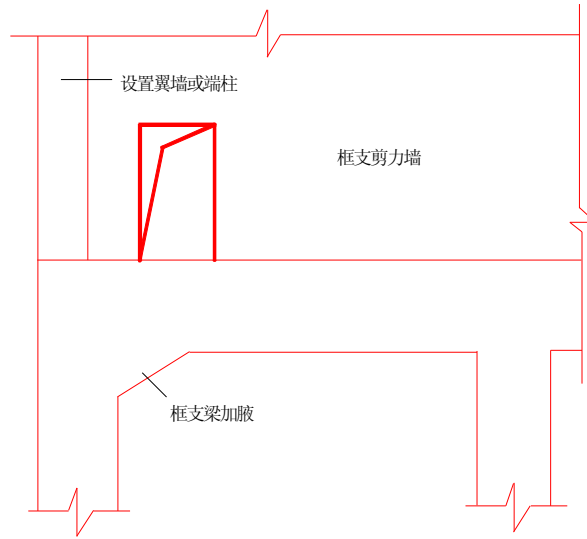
框支梁上墙体有边门洞时洞边墙体的构造措施
